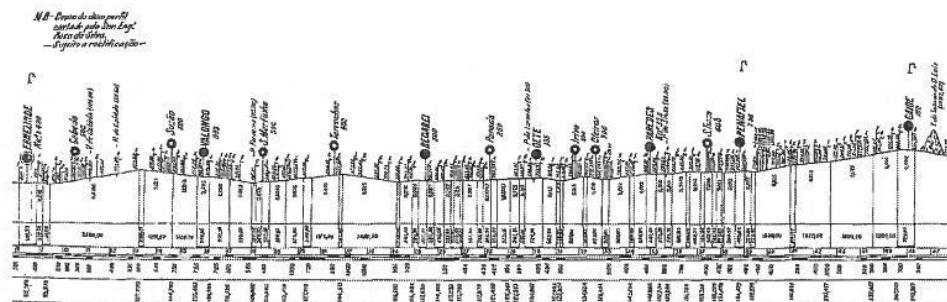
Perfil longitudinal entre Ermesinde e Caíde
